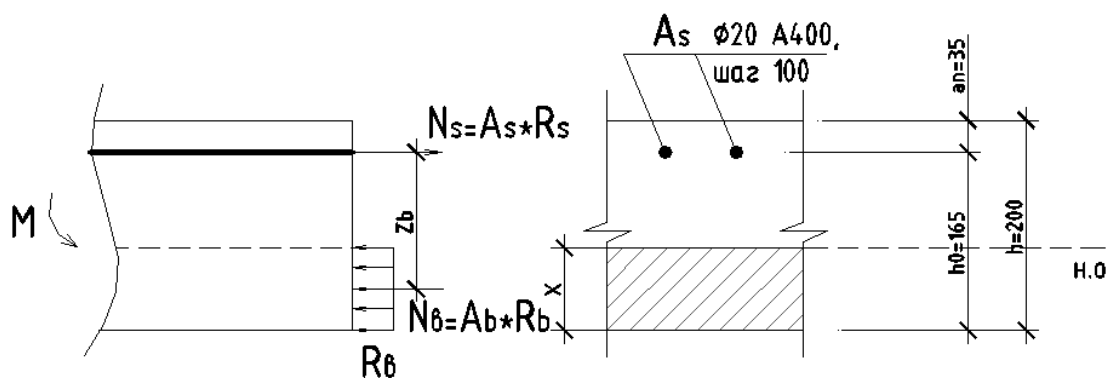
Схема внутренних усилий плиты над залом на опоре
